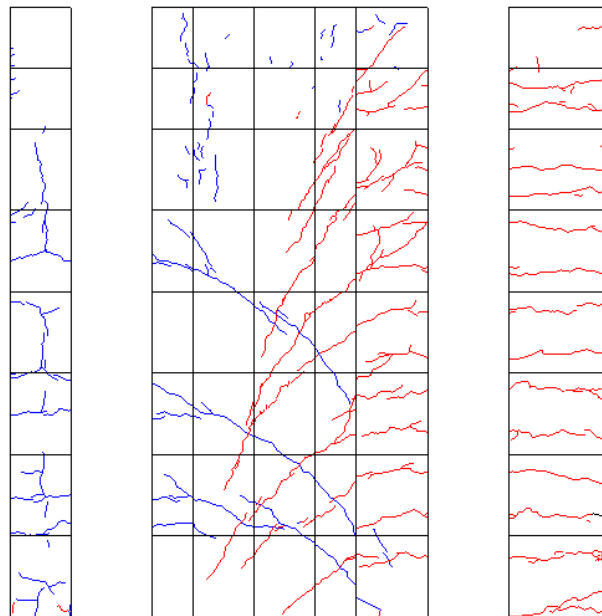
R=-1/100 ひび割れ図
